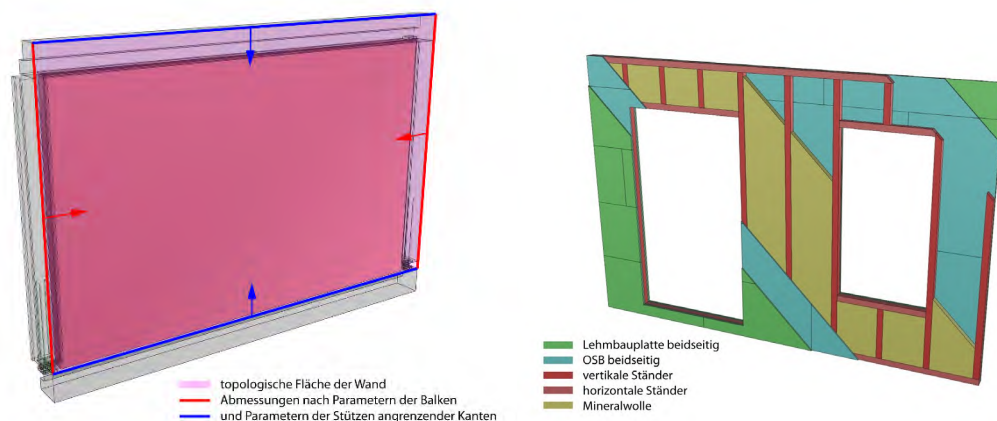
Schematischer Aufbau einer detaillierten Holzträgerwand
